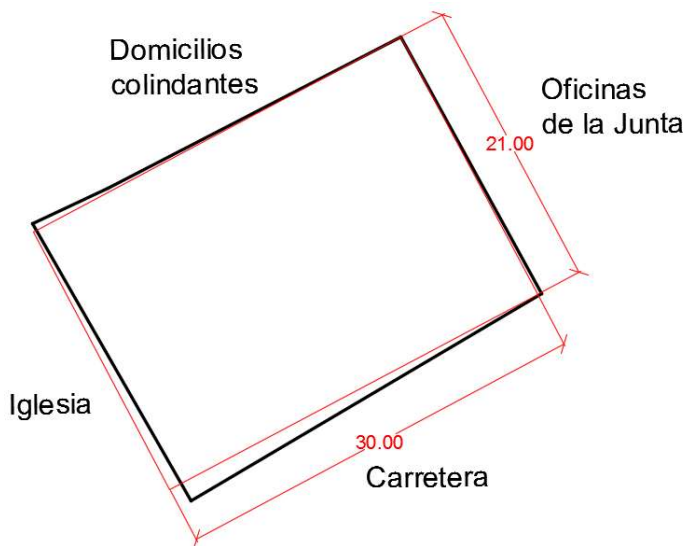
Plano del terreno definitivo de emplazamiento de la nave industrial
